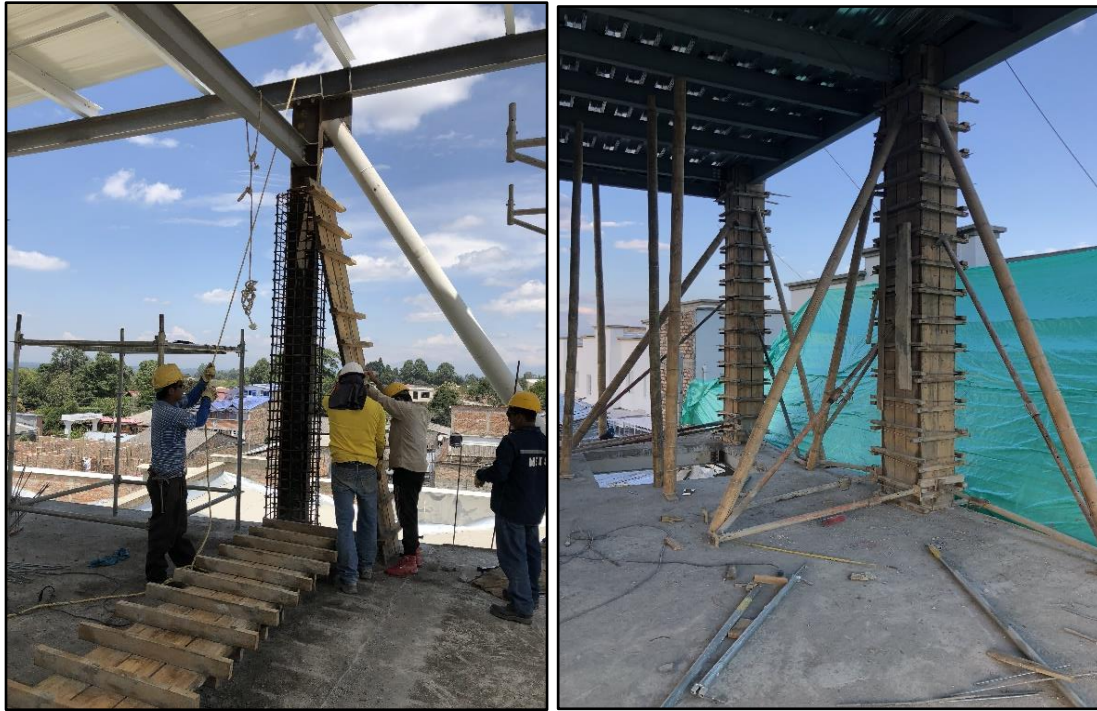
Encofrado de columnas. Fuente: tomada por el pasante.
